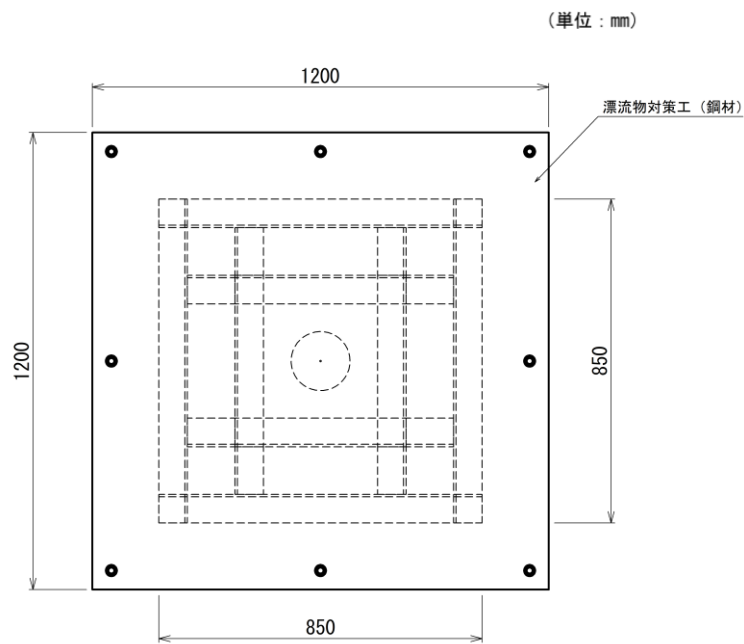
(1) 漂流物対策工 (鋼材) の構造概要図 (平面図)
